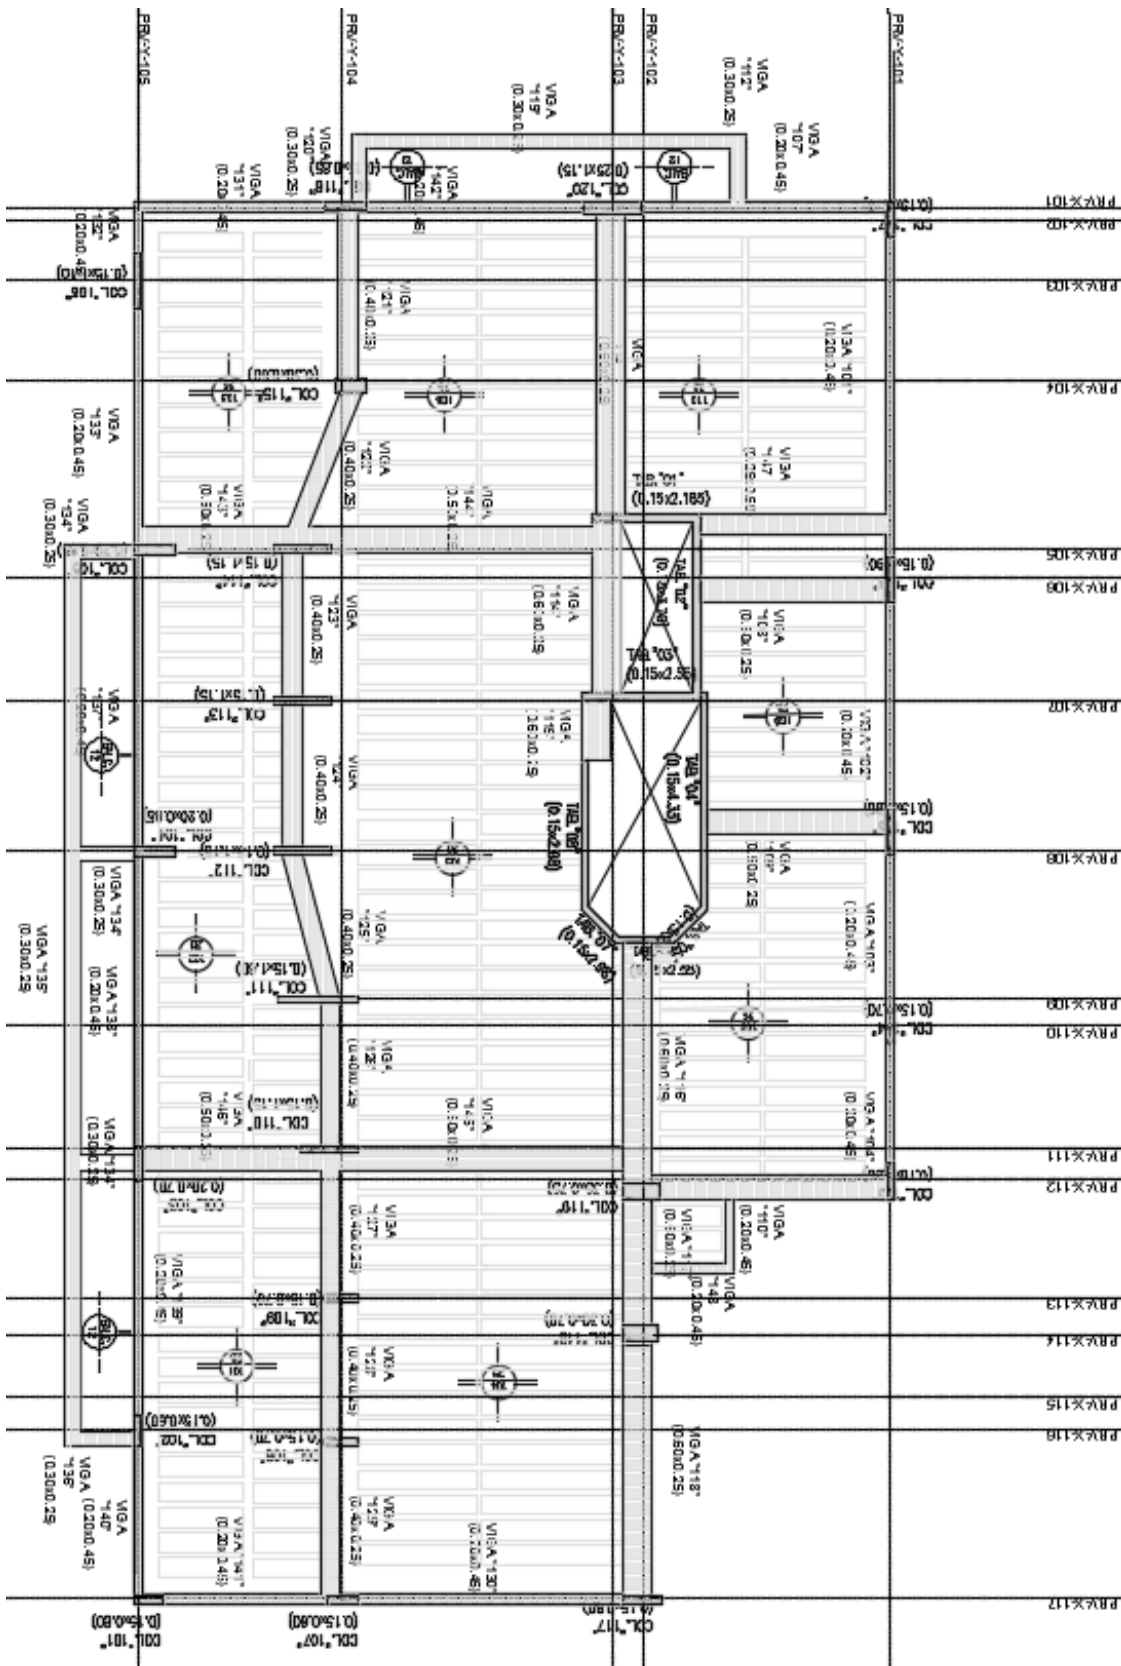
Plano con las dimensiones de los elementos estructurales.
